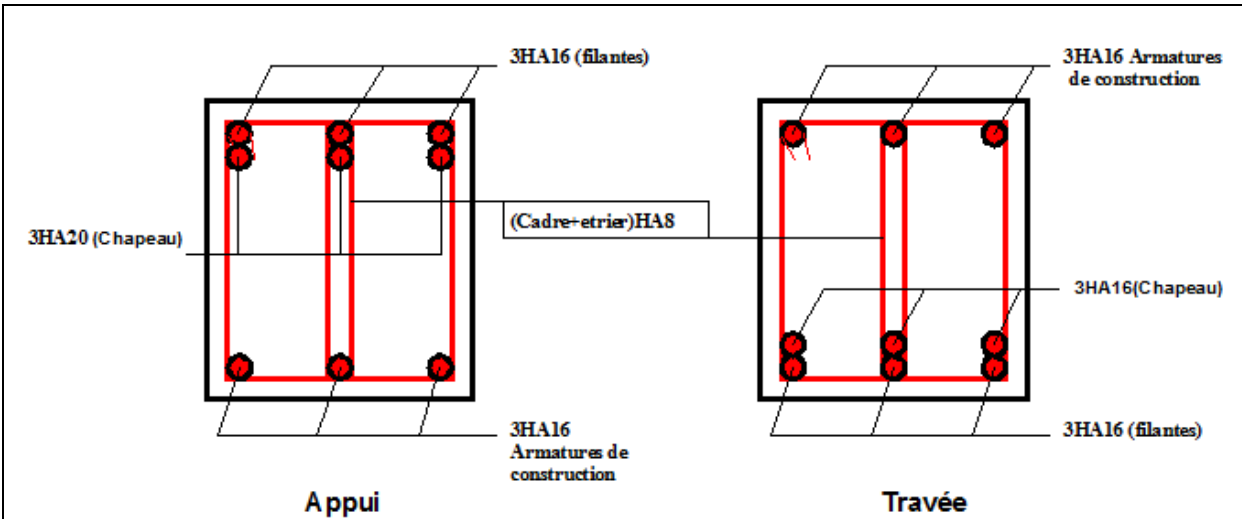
Schémas de ferrillages des poutres secondaires (RDC et étages courants).
